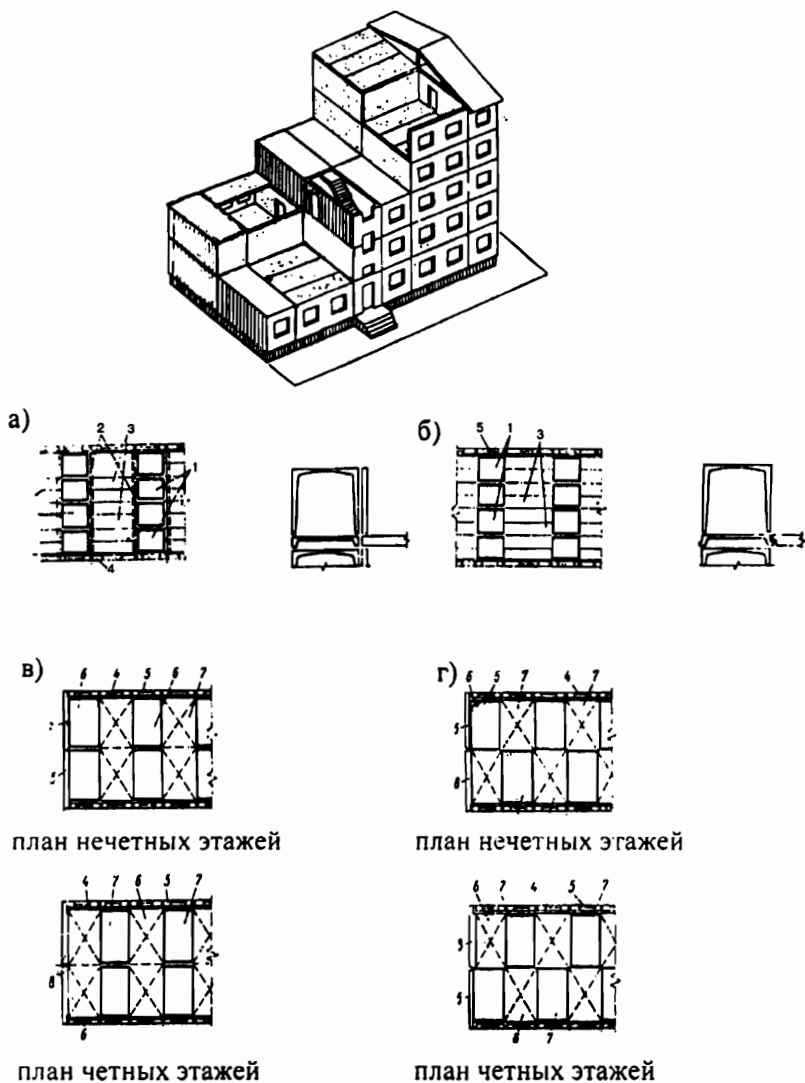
Блочно-панельная конструктивная схема объемно-блочных зданий и основные варианты расположения конструктивных элементов: а - раздельная, с передачей нагрузок от панельного пролета на самостоятельные несущие стены; б - без несущих панельных стен, с передачей нагрузок от панельного пролета на выступ панели пола блока; в - с шахматной расстановкой объемных блоков по вертикали; г - с шахматной пространственной расстановкой блоков; 1 - несущие объемные блоки; 2 - внутренние несущие стены; 3 - панели перекрытий; 4 - панели наружных стен; 5 - наружные стены объемных блоков; 6 - несущие объемные блоки нечетных этажей; 7 - то же, четных этажей; 8 - несущие панели торцевых стен
